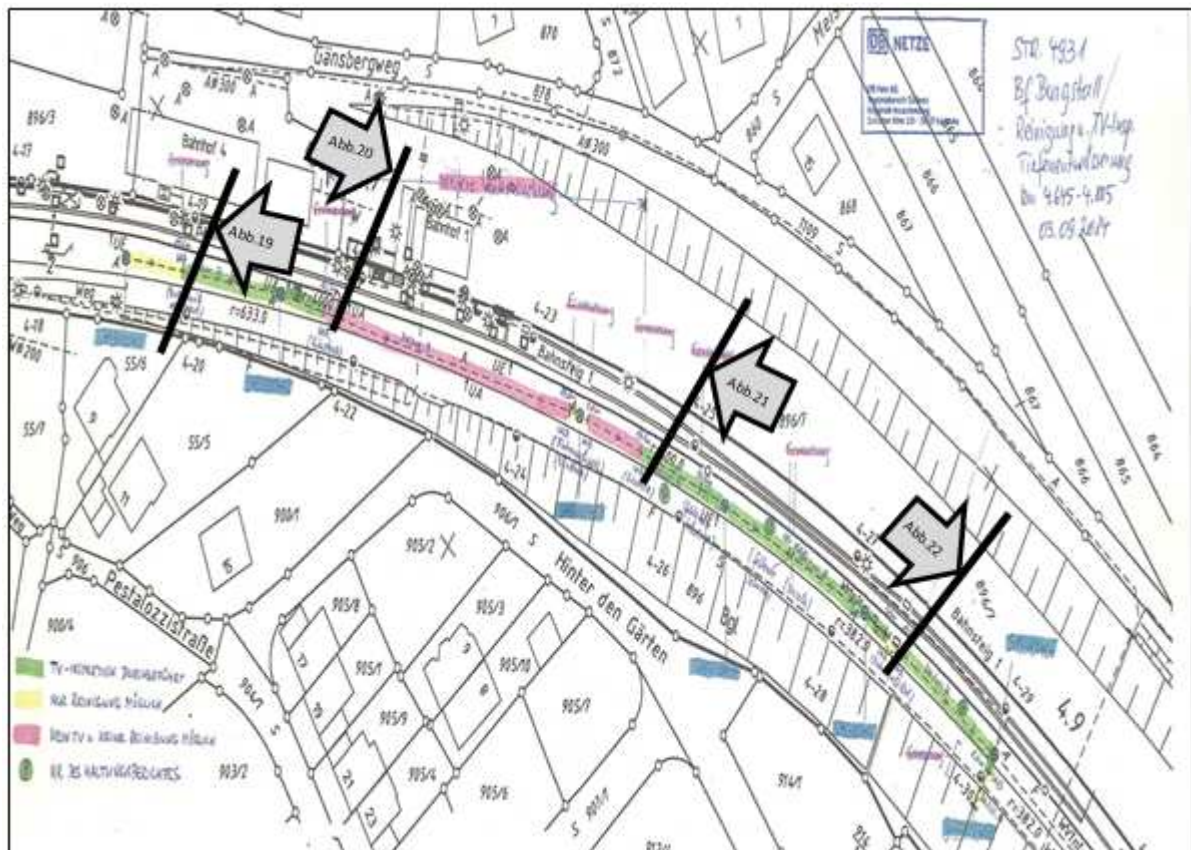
Übersichtslageplan der Kamerabefahrung vom 03.09.2014
